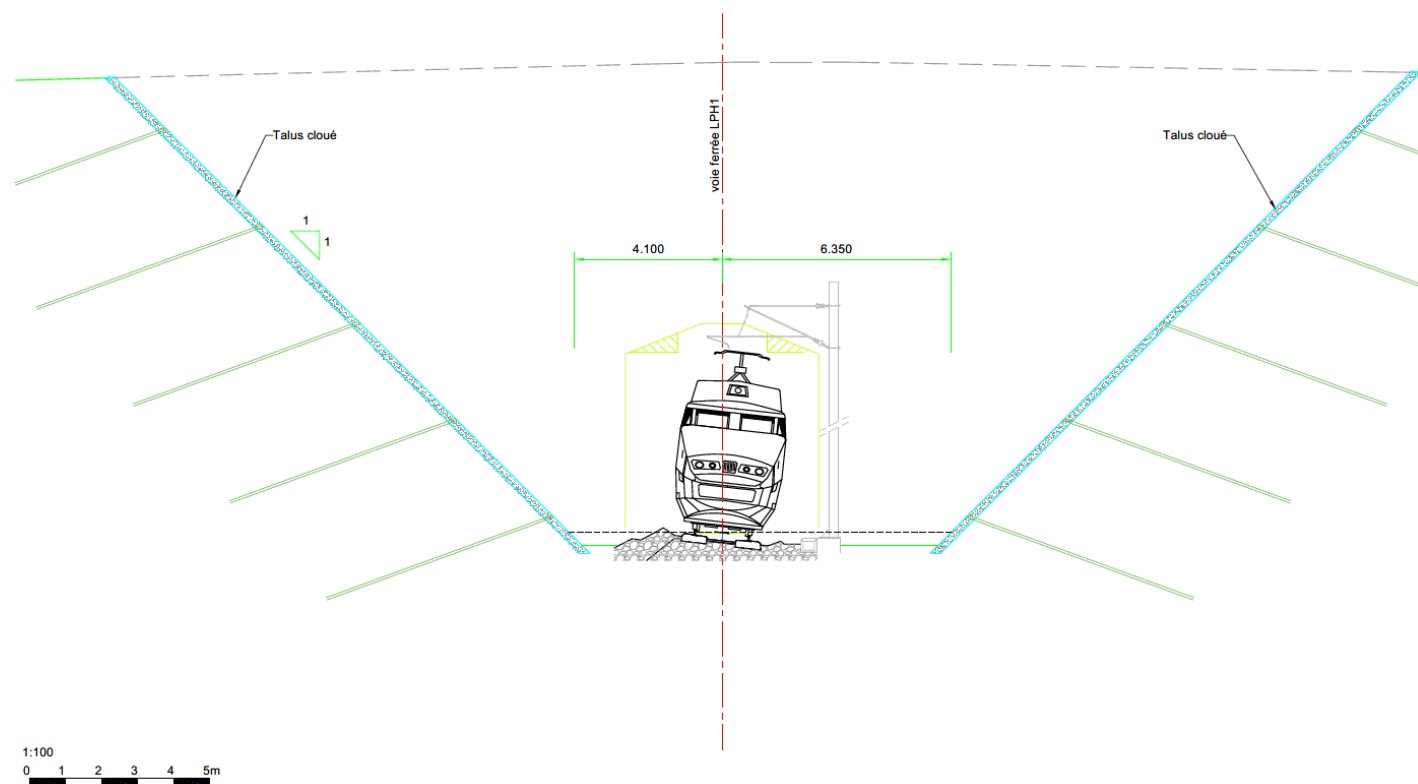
Coupe 3 - Vue en coupe de la rampe d'accès est du terrier (source : Egis, 2021)
